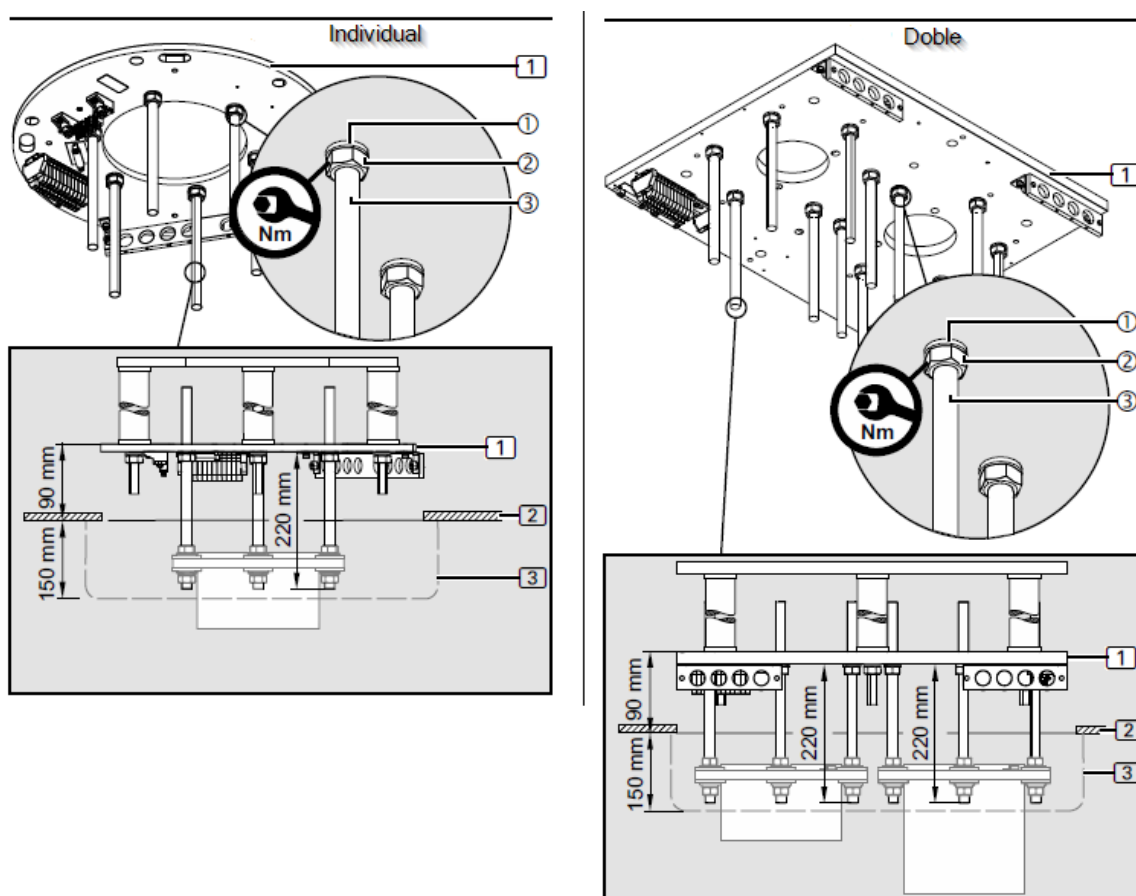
Montage de la plaque d'interface avec le faux plafond
